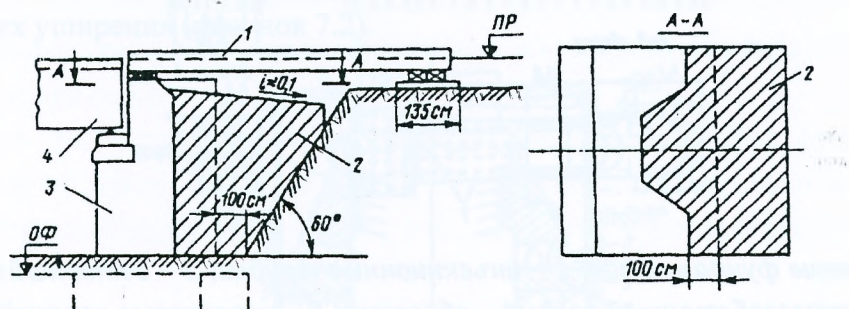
Устройство сухой кладки за устоем: 1 – инвентарное пролетное строение; 2 – сухая кладка; 3 – устой; 4 – пролетное строение.
